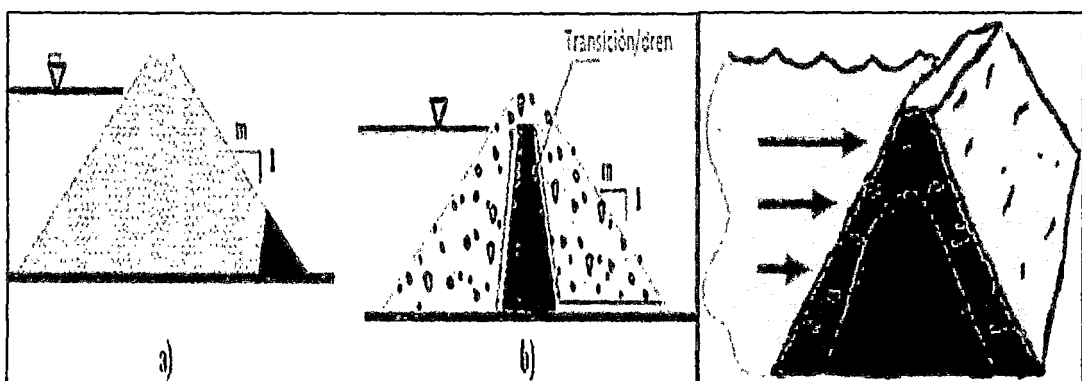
a) Presa de tierra con dren de pata. b) Presa de enrocado con núcleo impermeable.
